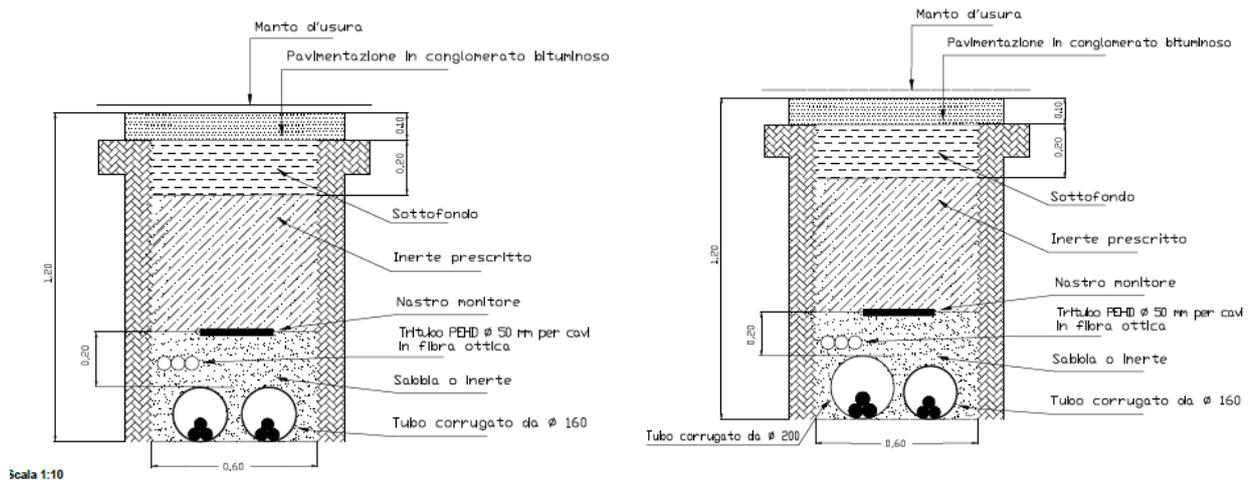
Sezione su strada asfaltata - posa di n°2 cavi MT
